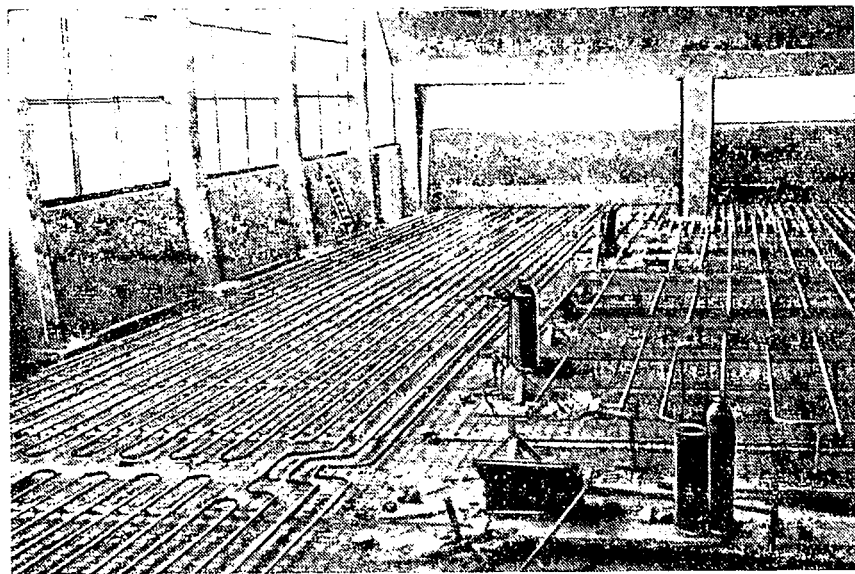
Общий вид системы трубопроводов водяного напольного отопления перед бетонированием
